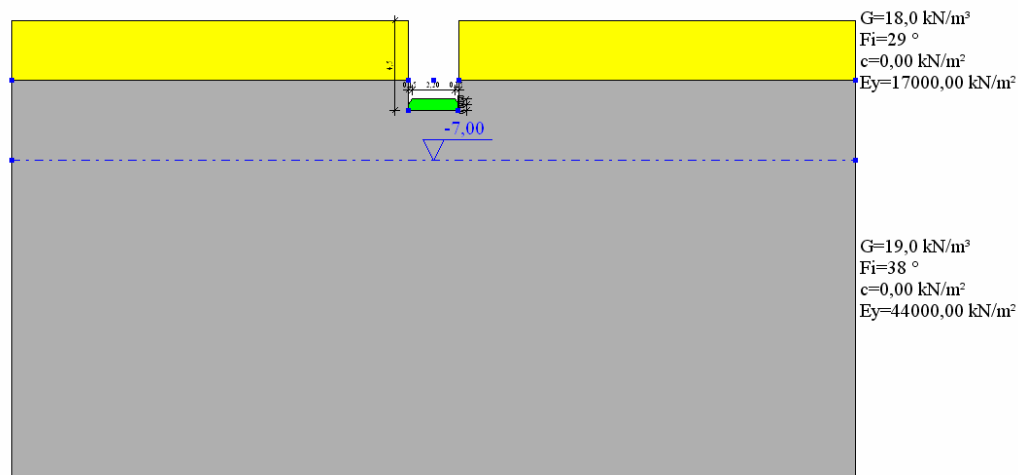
Schema della situazione di calcolo per i cedimenti dei plinti.
